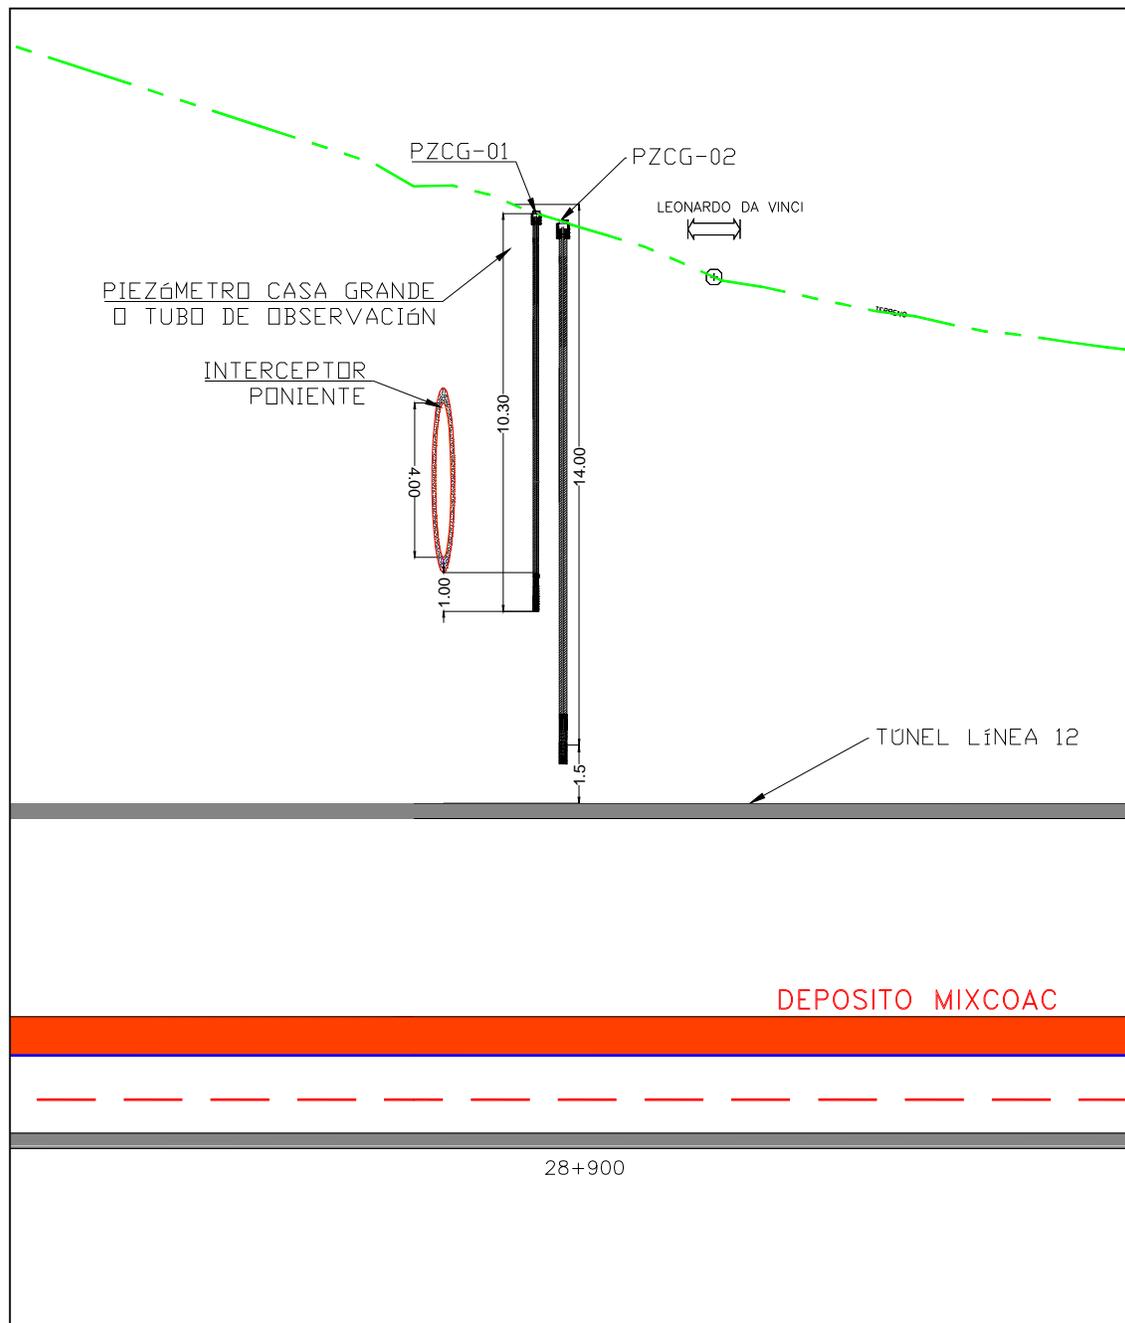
Corte transversal de instalación de Piezómetros tipo Casagrande.
